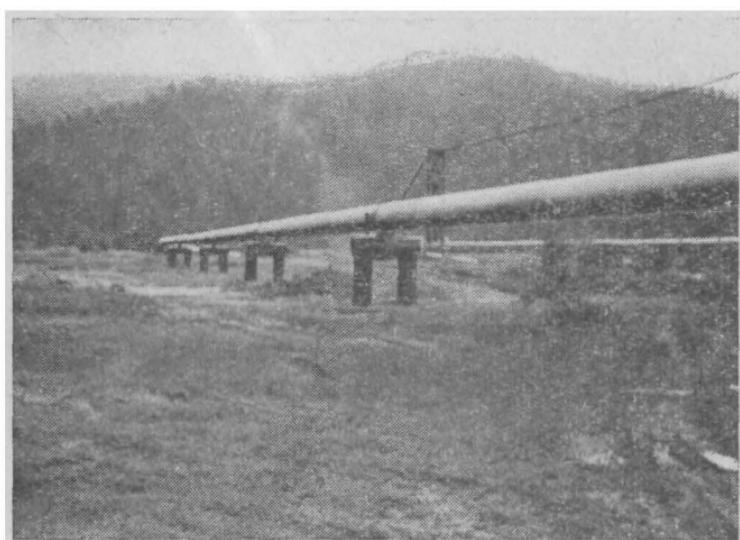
Многопролетный балочный переход трубопровода в горных условиях
